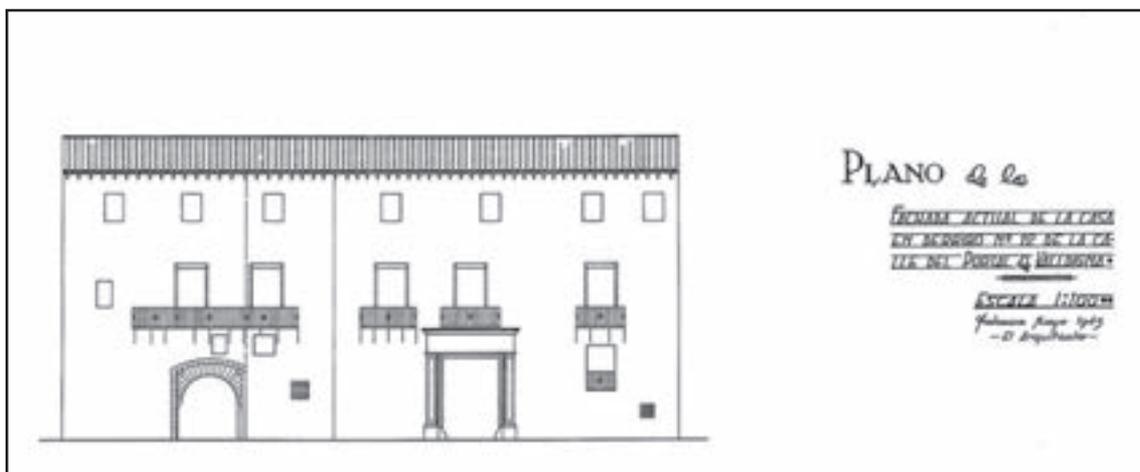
Levantamiento, anterior a la reforma, de las fachadas que iban a ser intervenidas. A.G.D.
